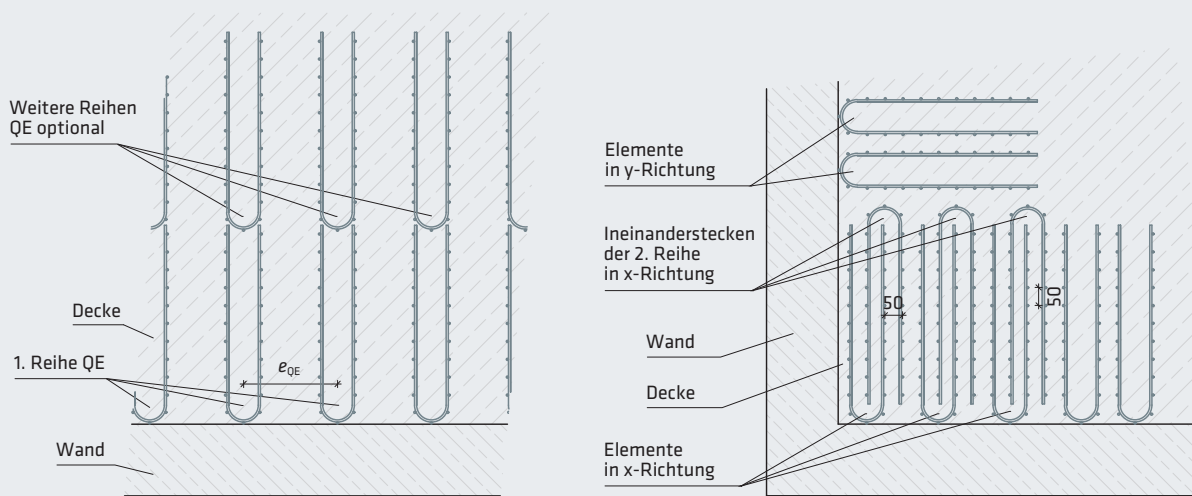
Verlegung im Grundriss – Deckenausschnitt (links) und Deckenausschnitt eines Eckbereiches (rechts)
